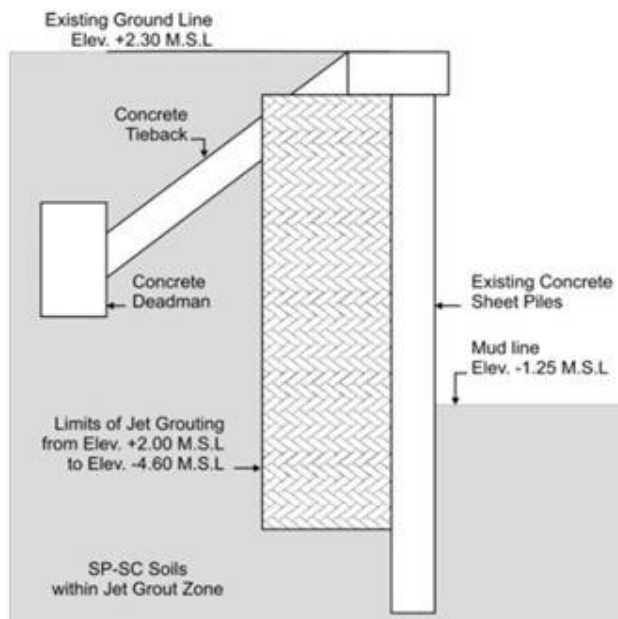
Поперечное сечение шпунтовой стенки после устройства грунтоцементных колонн [15]
